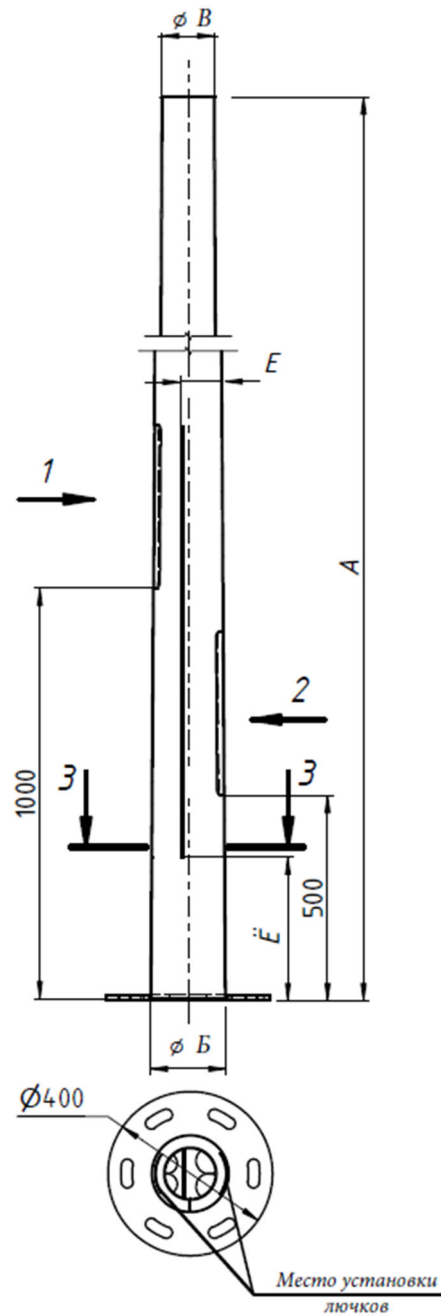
Внешний вид и размеры опор серии SP-9.
